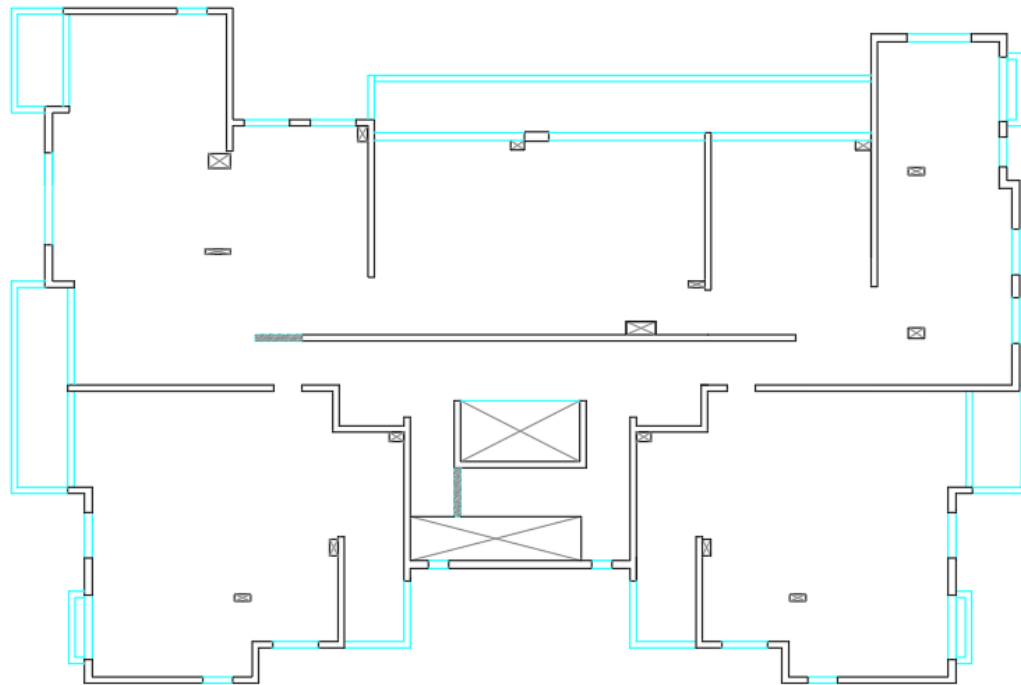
Adaptación de plano estructural de planta del piso 16.
